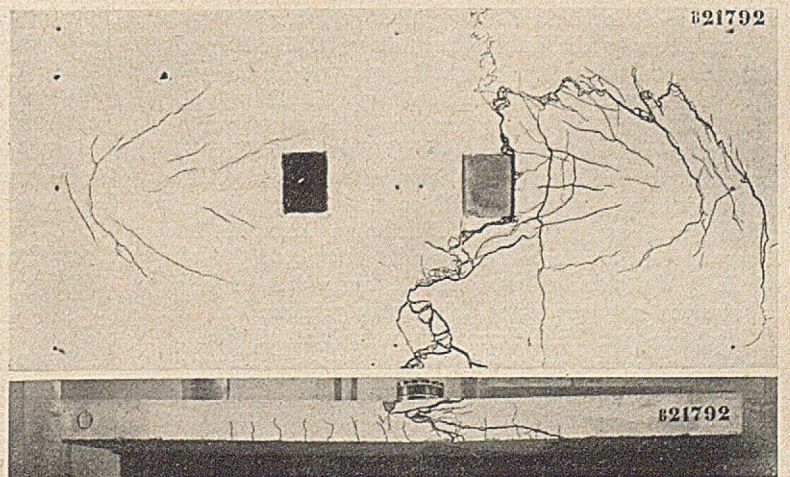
Rissebildung in der Stahlbetonplatte.
